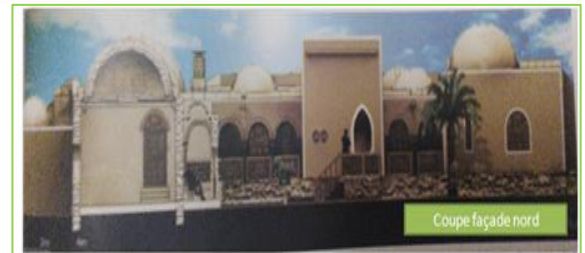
Façade nord. Source : revue vies de ville N°22
